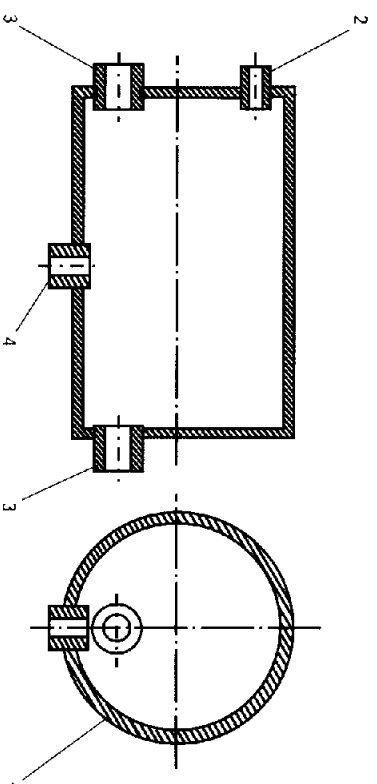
Проточний розширювальний бак атмосферного типу
